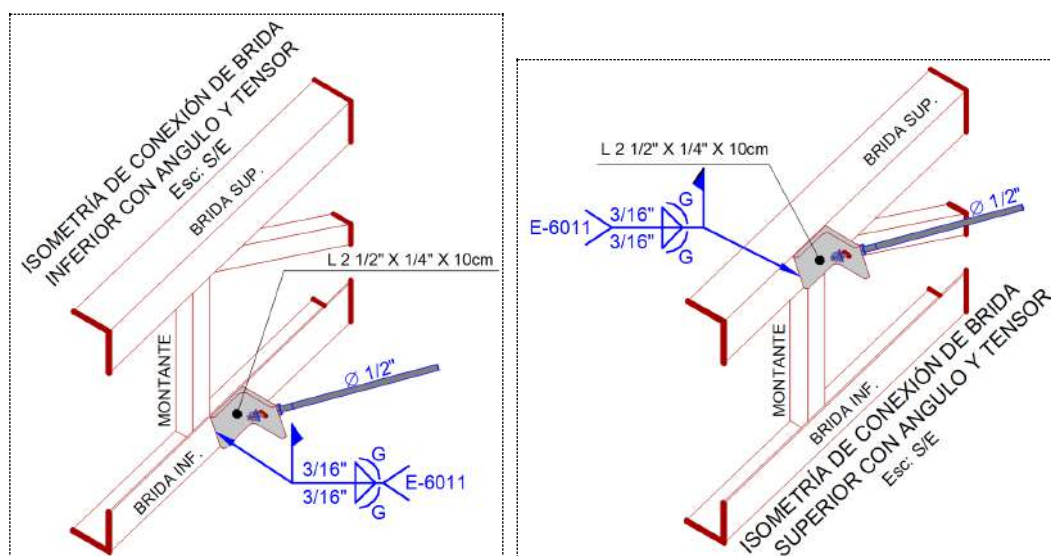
Detalle del proceso de montaje de viguetas y soldadura
